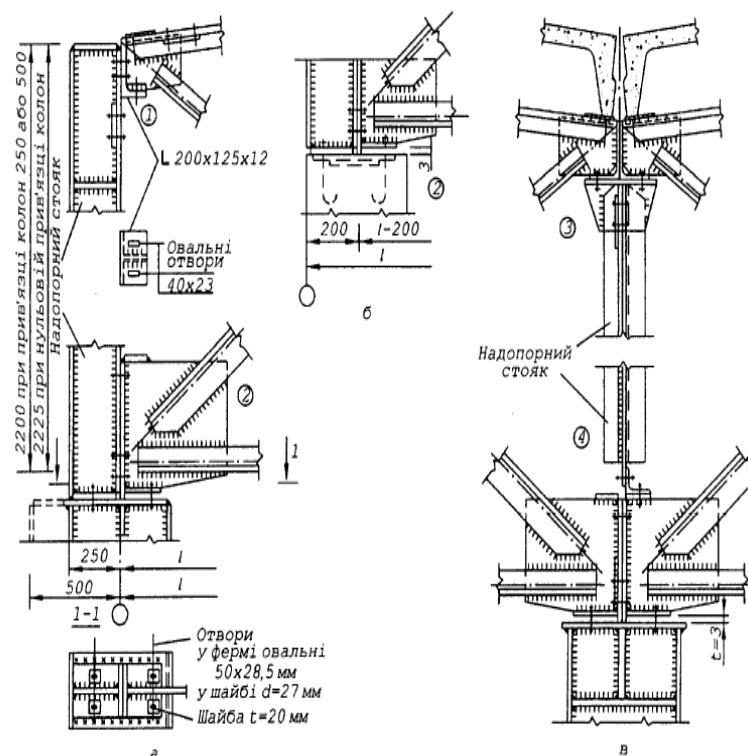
Опорні вузли з прикріпленням ферм до колони зверху з обпирання на крайню (а) та на середню (б) колони
